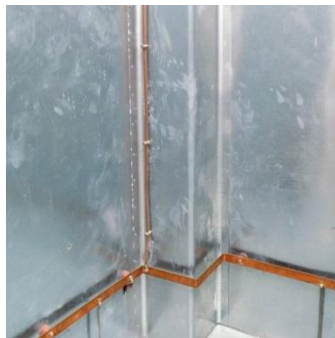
Baixada para ligação dos barramentos principal e secundário
